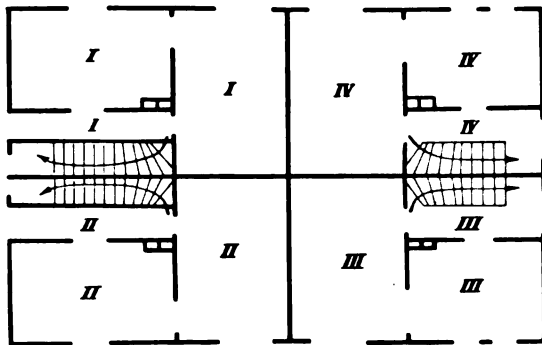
Grundriß eines Hauses mit 4 durch senkrechte Teilung des Hauses getrennten Wohnungen.
